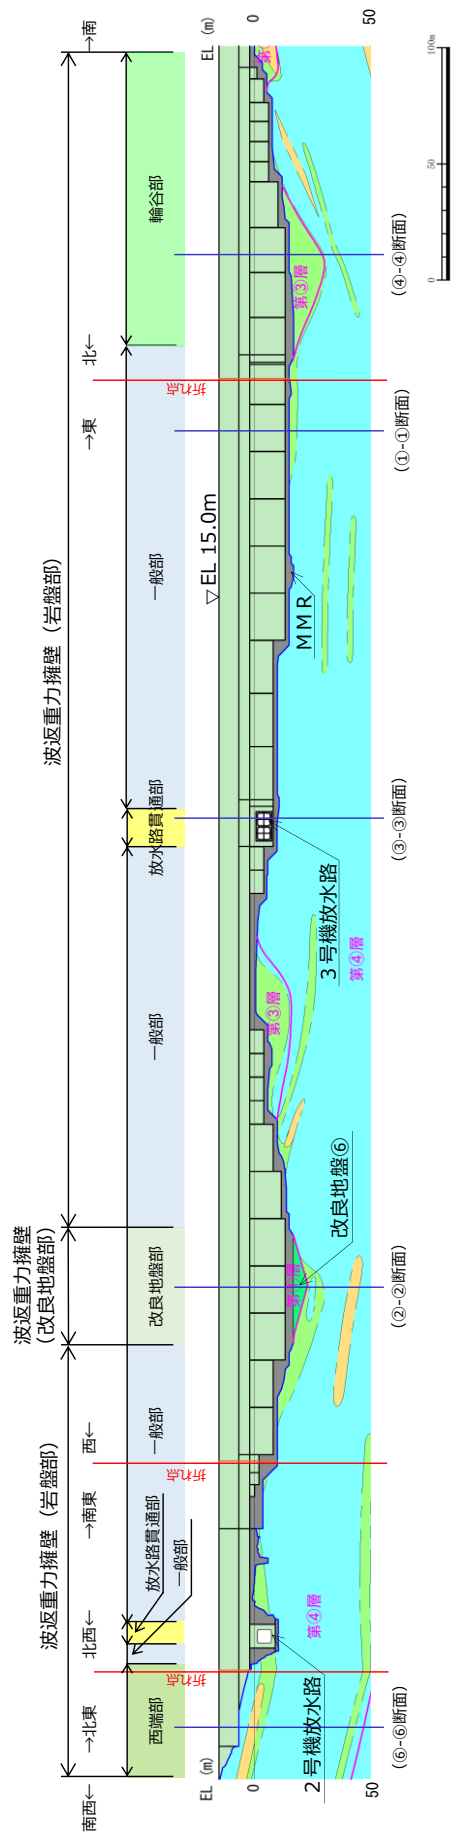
防波壁（波返重力擁壁）の縦断面図
